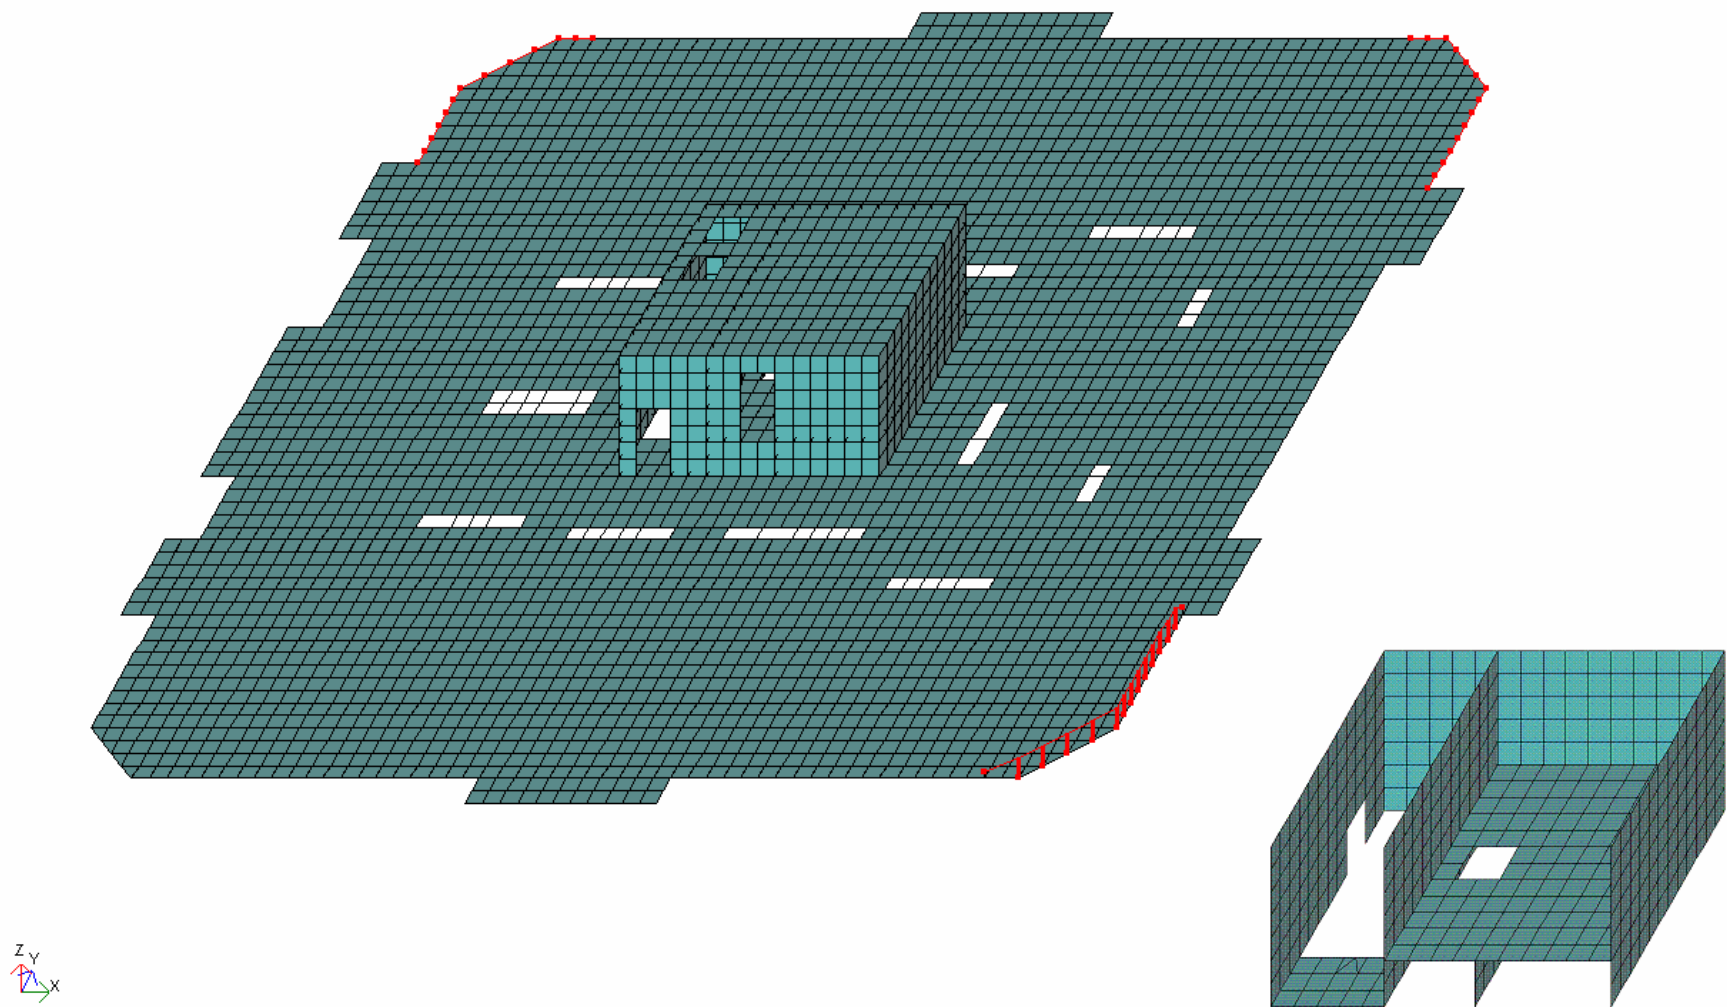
Кровля. Выделены ребра жесткости (балки) на краях покрытия здания.
